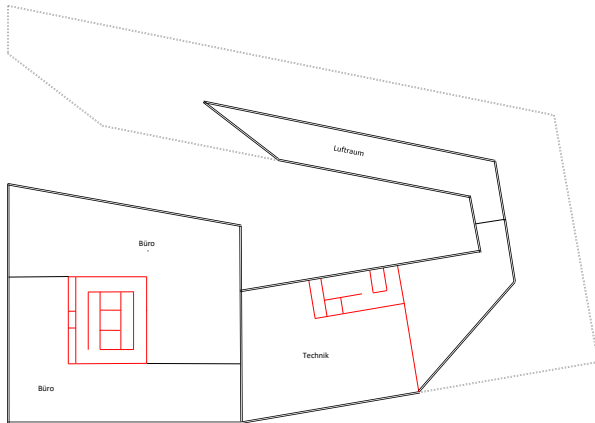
Grundriss Beispiellobjekt - E+7
